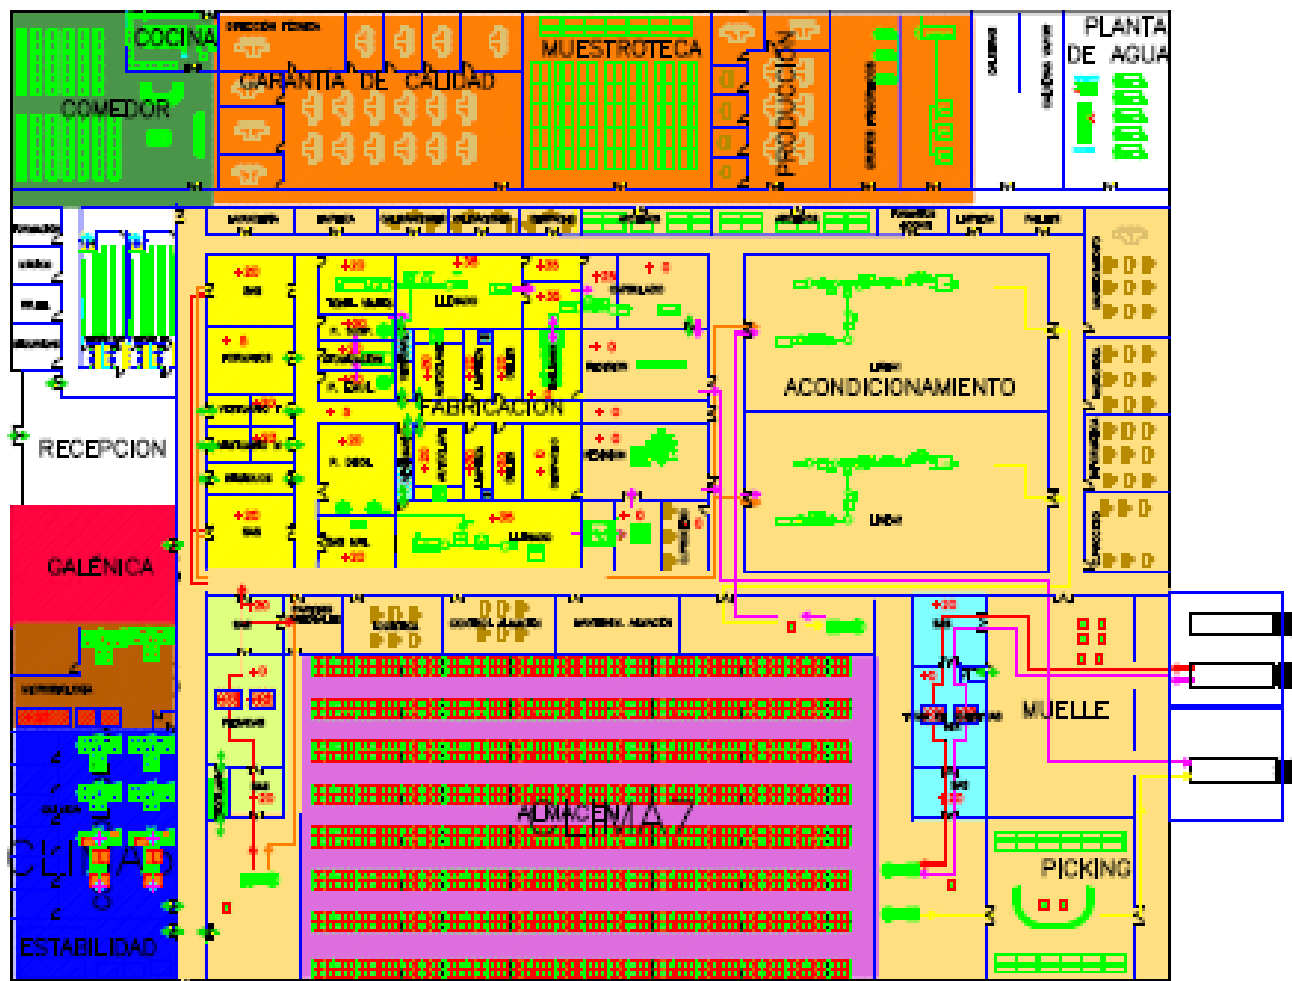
Plano de climatizadores de la planta industrial de fabricación.
